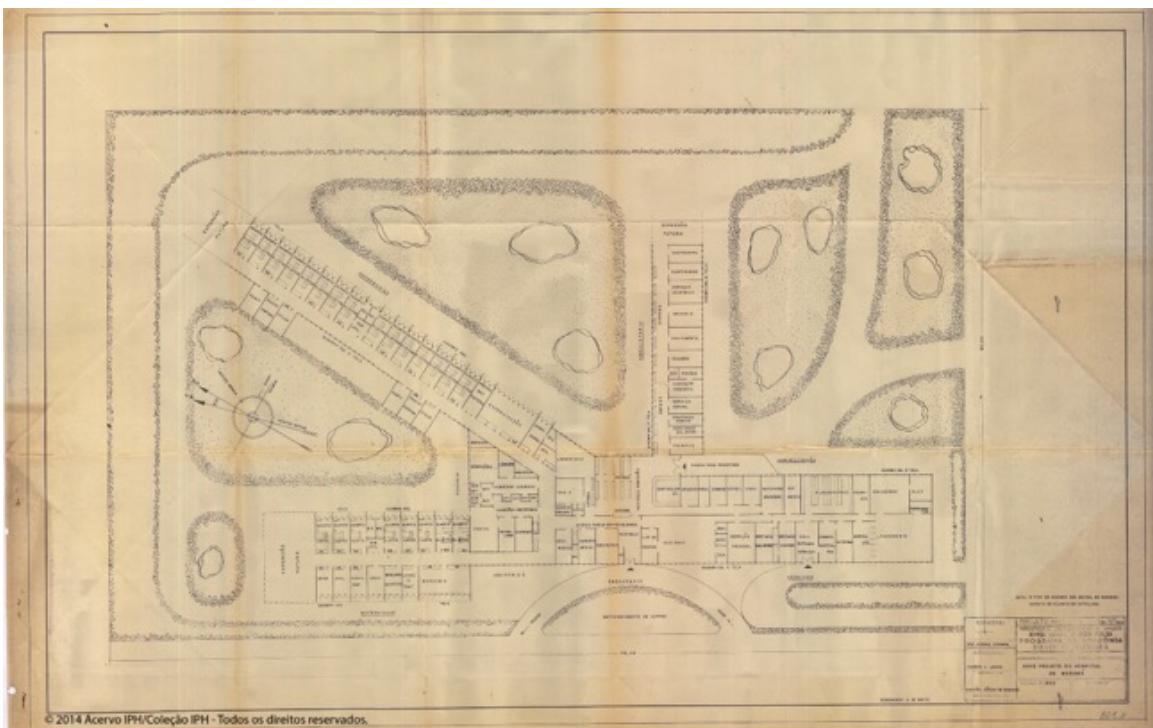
Plano con la planta baja de la segunda versión del Hospital de Marabá
